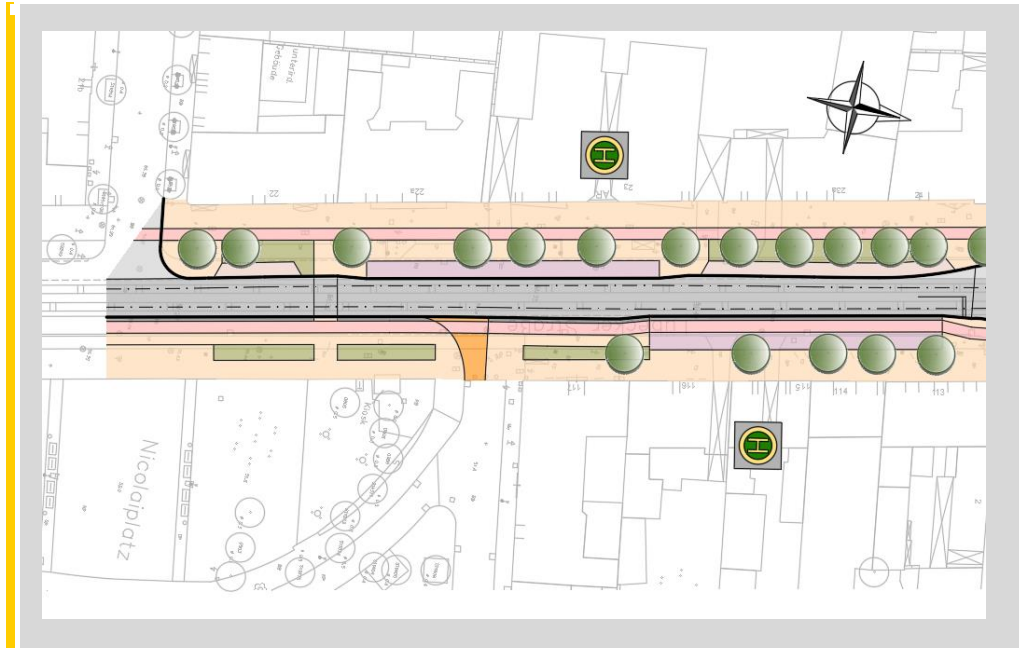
Lübecker Straße Mitte, Lageplanausschnitt V2
